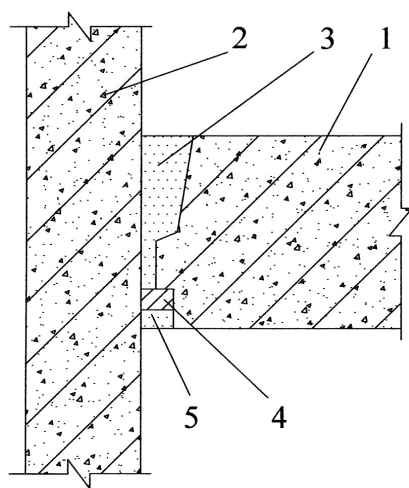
Схема конструктивного решения узла примыкания перекрытия к стене.
